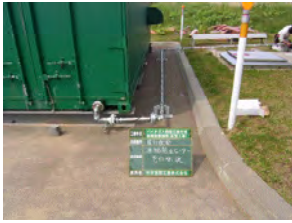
ヒーター巻付状況 写真-8 保温材巻付状況
